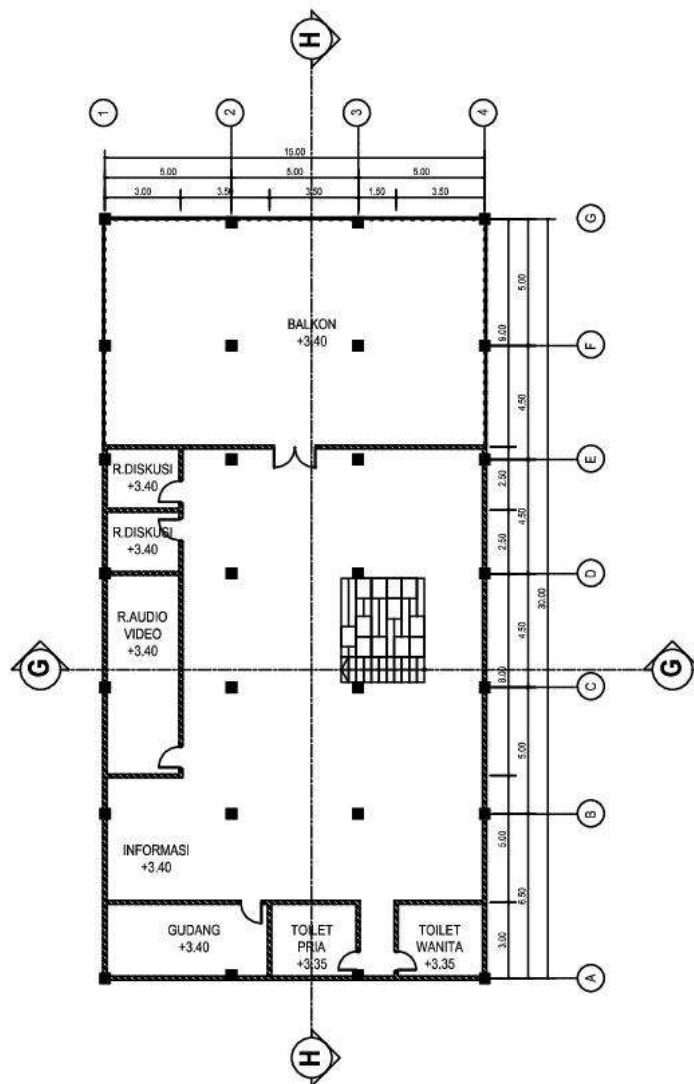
Denah Tempat Penitipan Anak Lantai 2
